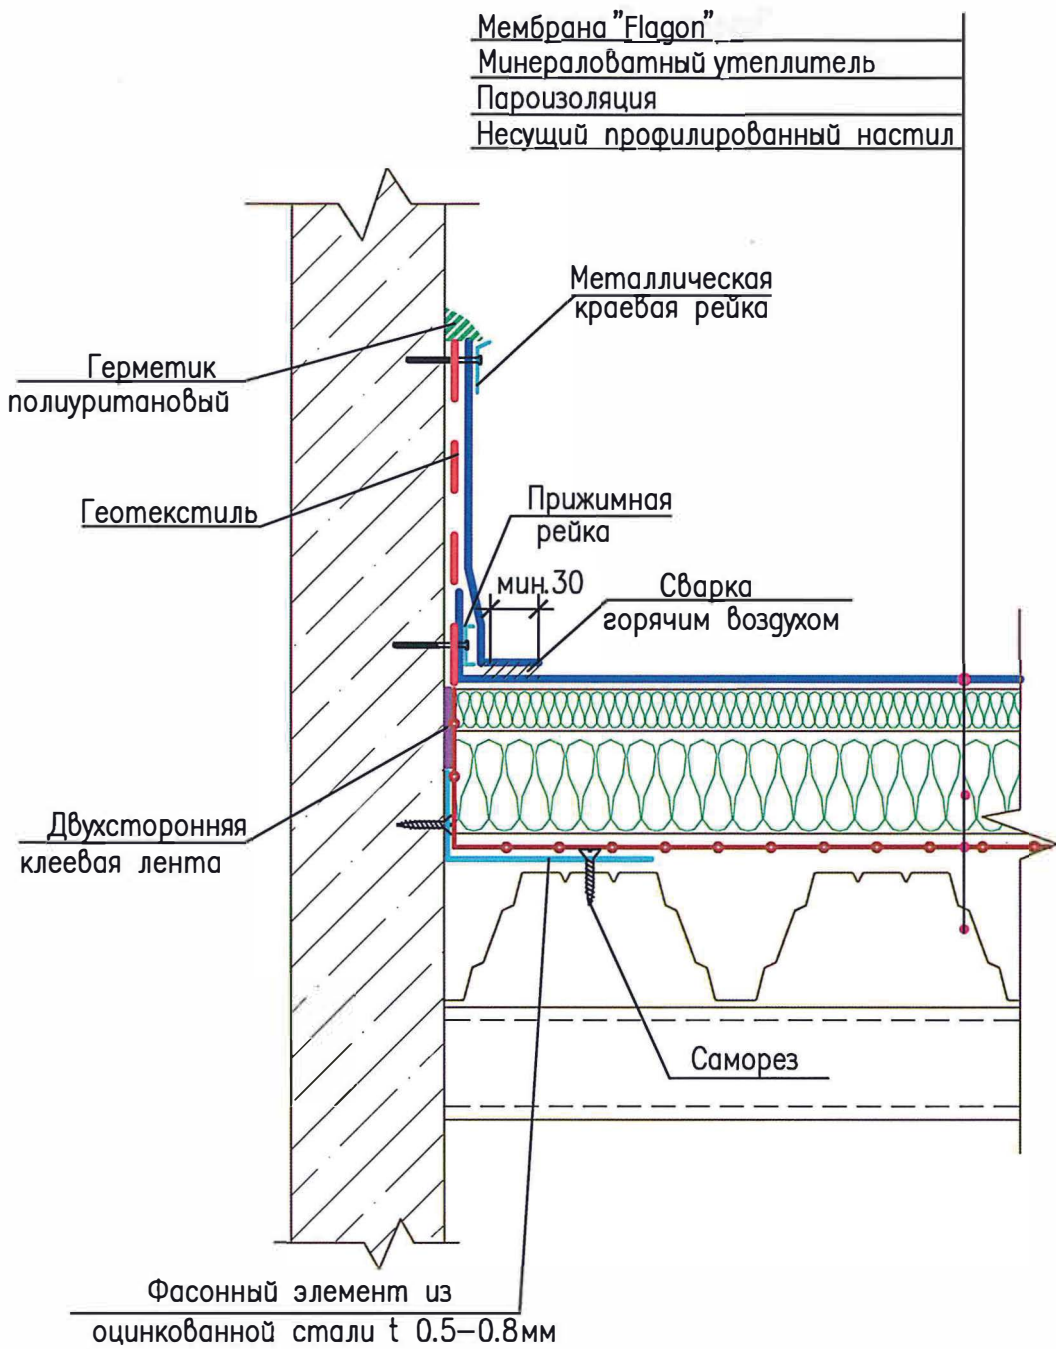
Конструктивные решения узлов для кровли с несущим профилированным настилом с механическим закреплением. Устройство примыкания к стене
